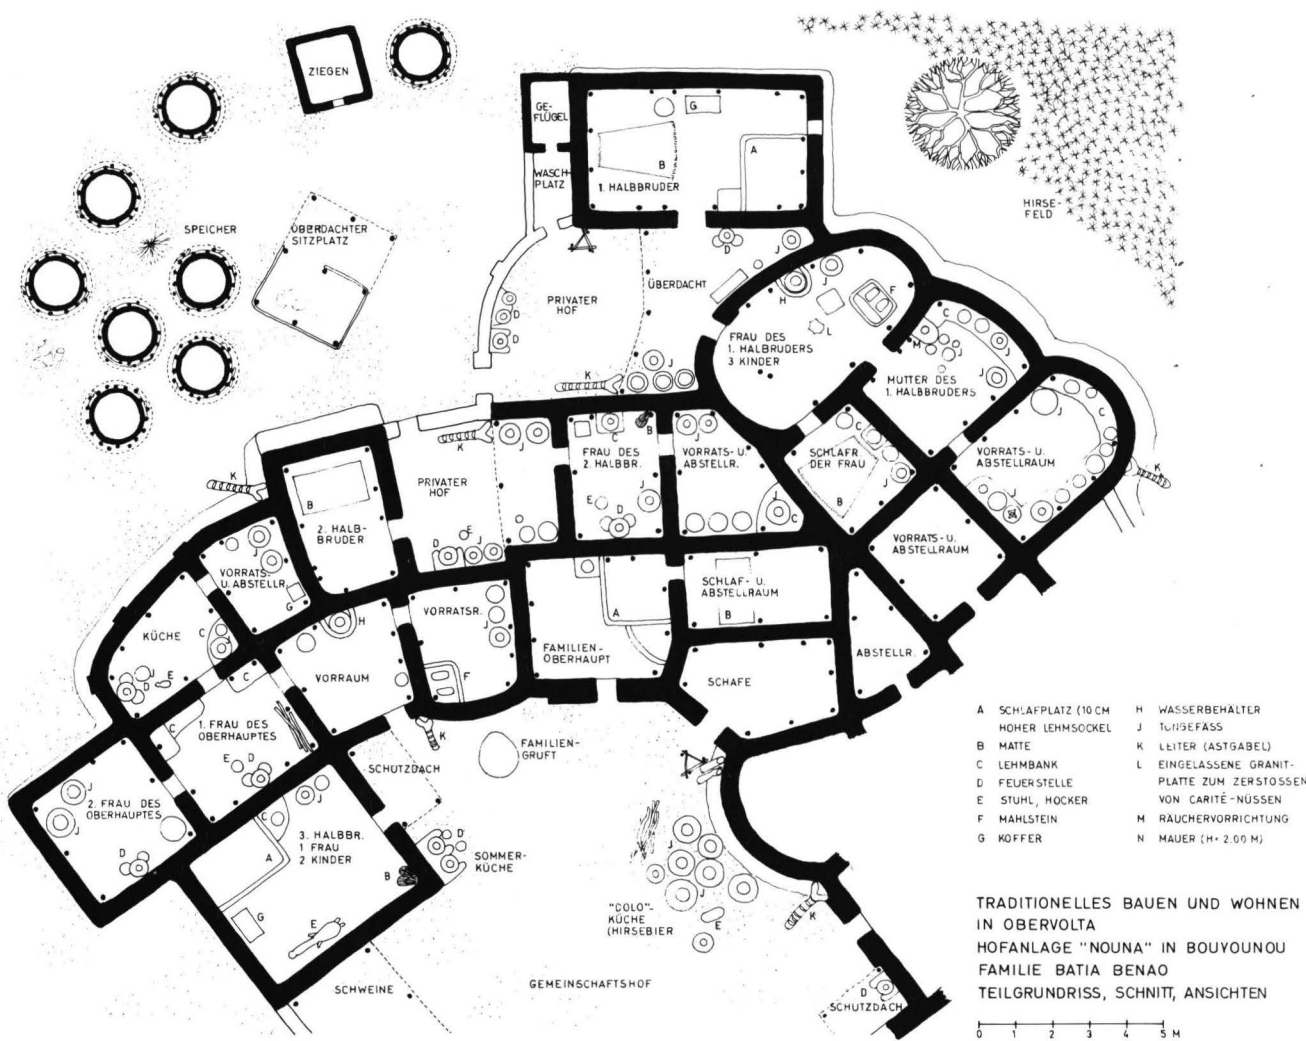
Traditionelles Bauen und Wohnen in Obervolta. Hofanlage „Nouna“ in Bouyounou (Teilgrundriß)
